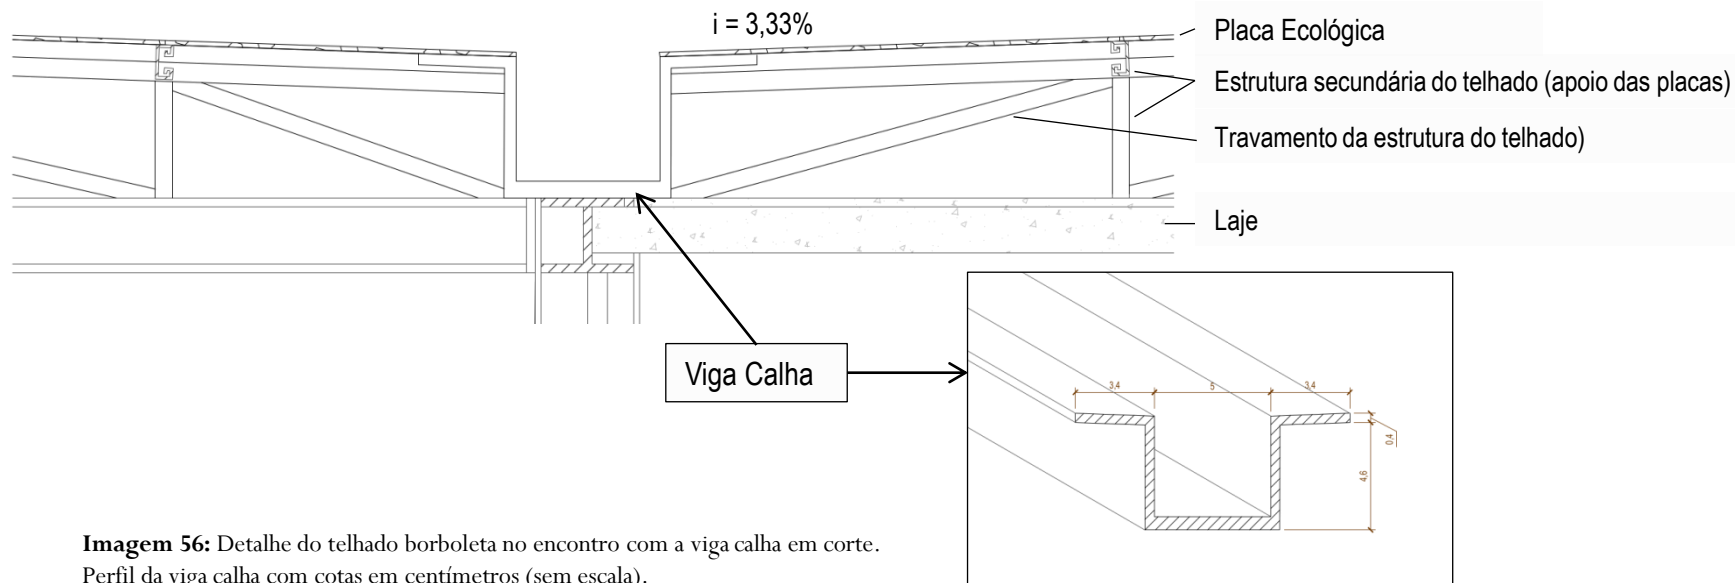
Detalhe do telhado borboleta no encontro com a viga calha em corte. Perfil da viga calha com cotas em centímetros (sem escala).
